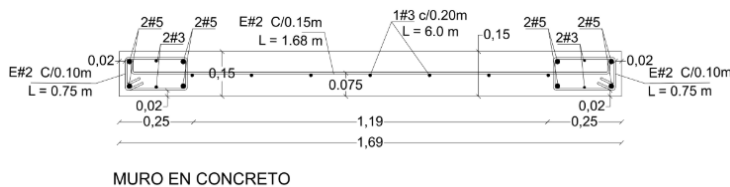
Muros Estructurales de Segundo Piso y Muros No Estructurales de Segundo Piso
